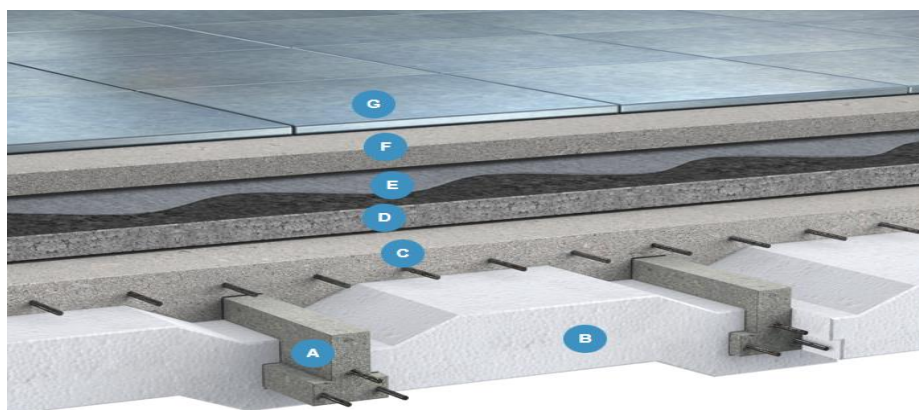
Schéma d'isolation d'un plancher ¹⁵
